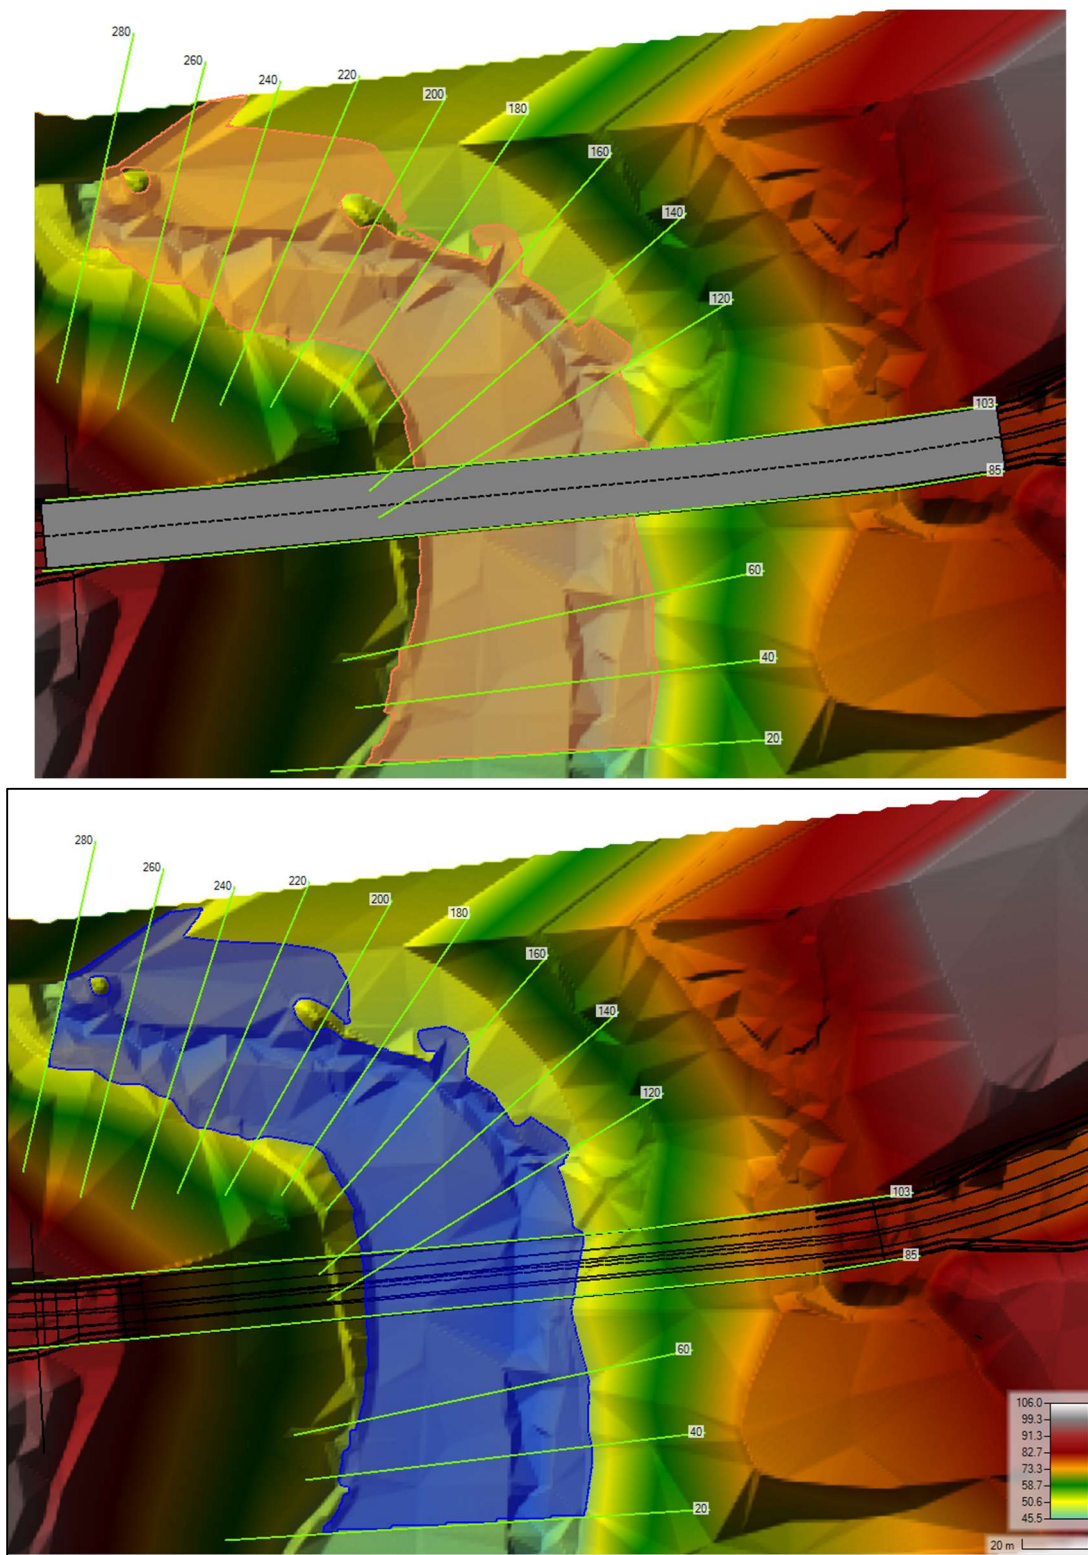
Aree di esondazione (Tr=200) su DTM nel Torrente Tenza prima e dopo la demolizione del viadotto T04 – VI03
